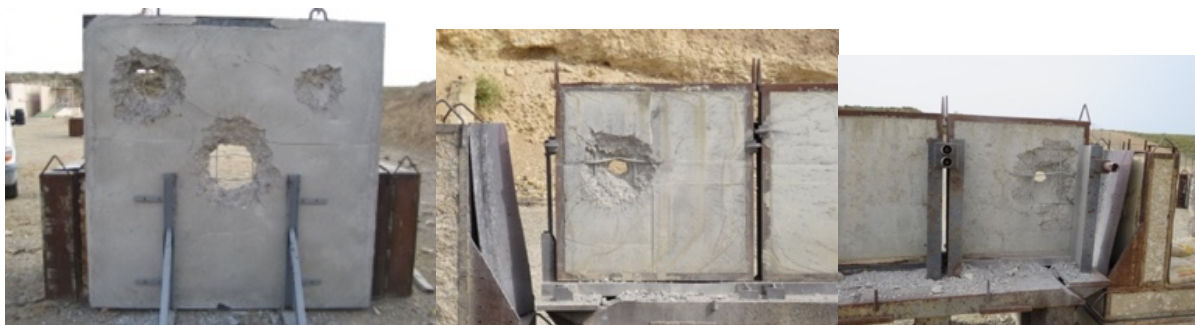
Efectos sobre blanco de hormigón armado HA-25 Fuente: Instalaza
